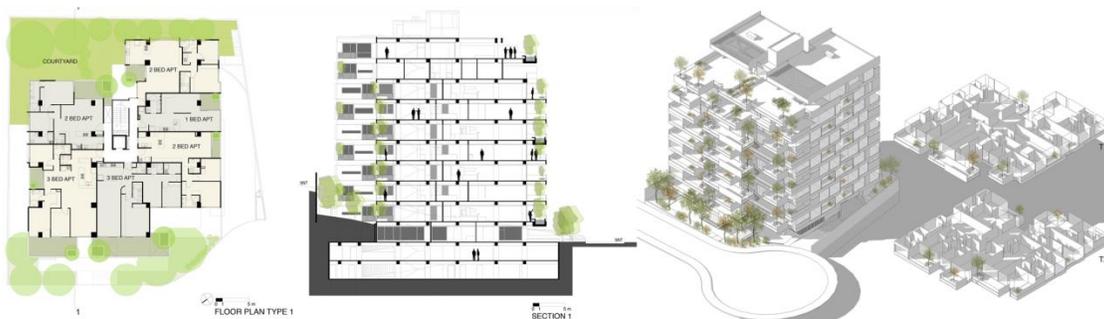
Referente de forma 4 - Edificio VIVIR PERMEABLE- Planos
